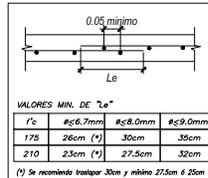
PLATEA DE CIMENTACIÓN - MÓDULO D3-M15
